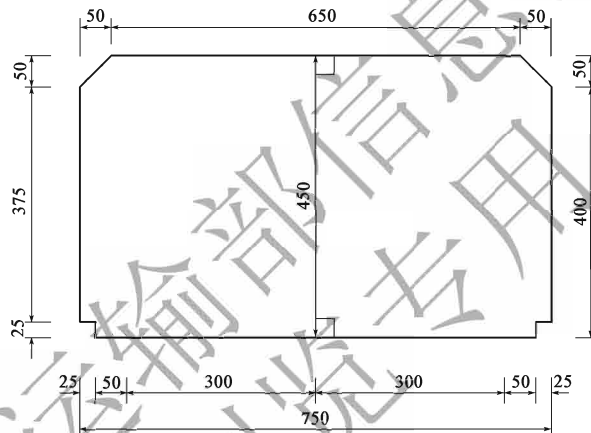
Dégagement de construction du tunnel routier de quatrième classe à deux voies (20km/h) (unité : cm)
